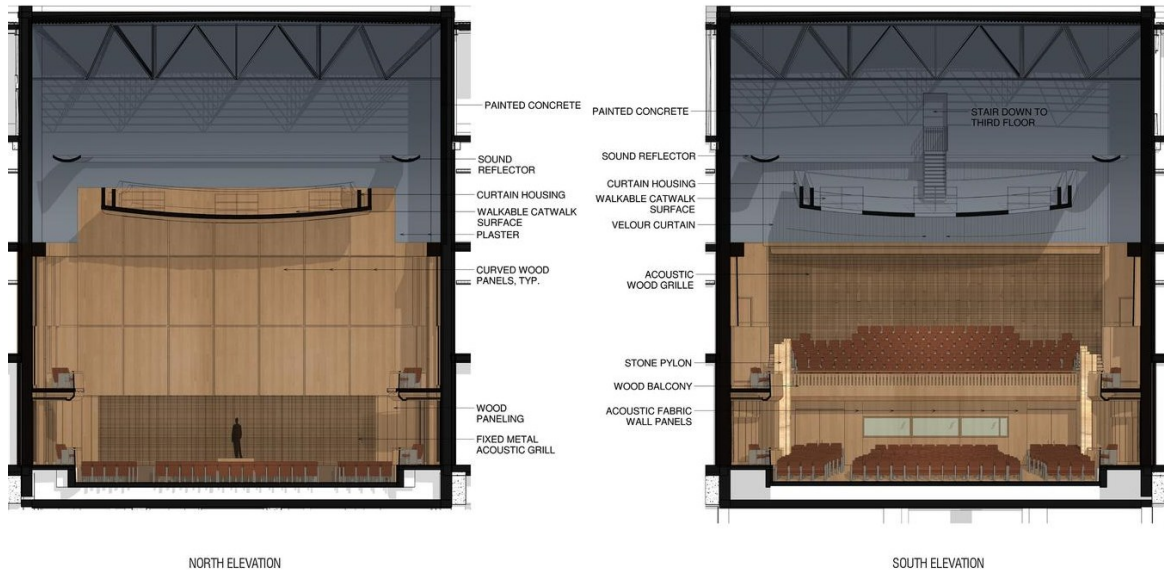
Detalle constructivo del auditorio Mary Gannon. Recuperado de <https://www.archdaily.pe/>
